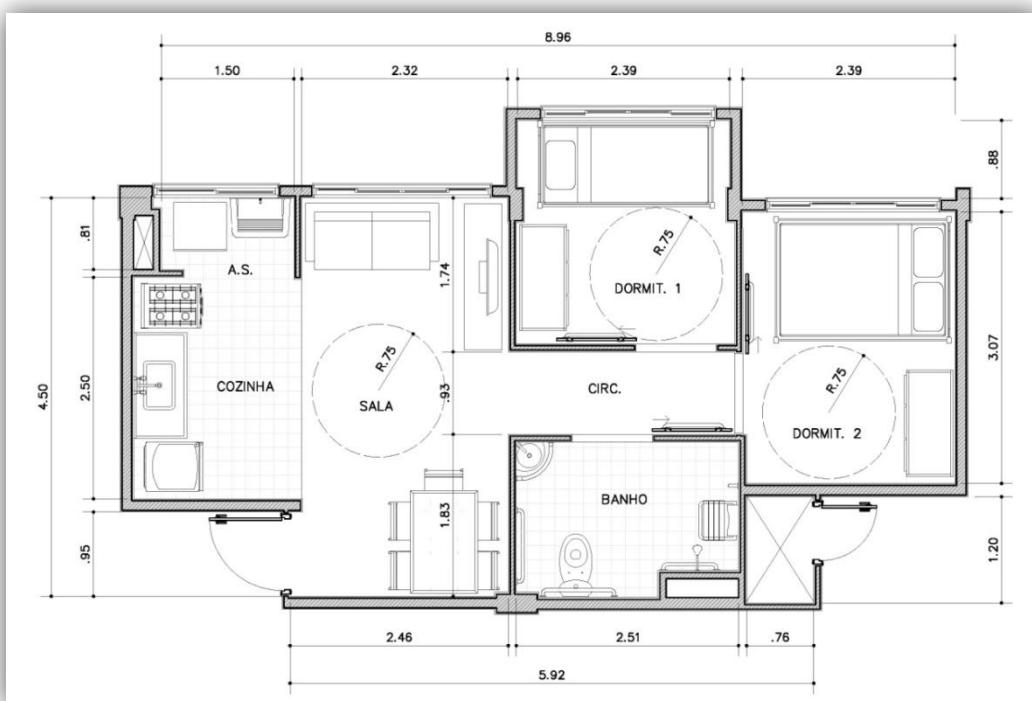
Planta do apartamento adaptado (V052-2 e V052-3); sem escala.
